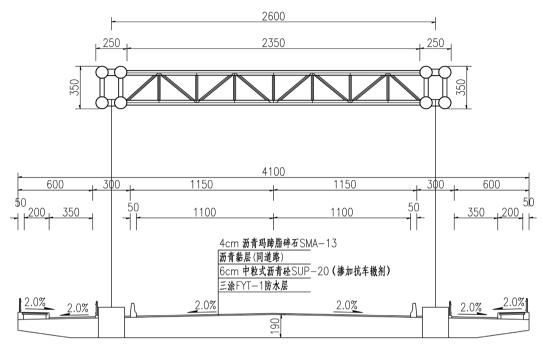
Cross section of bridge superstructure 图 2. 桥梁上部结构断面图
